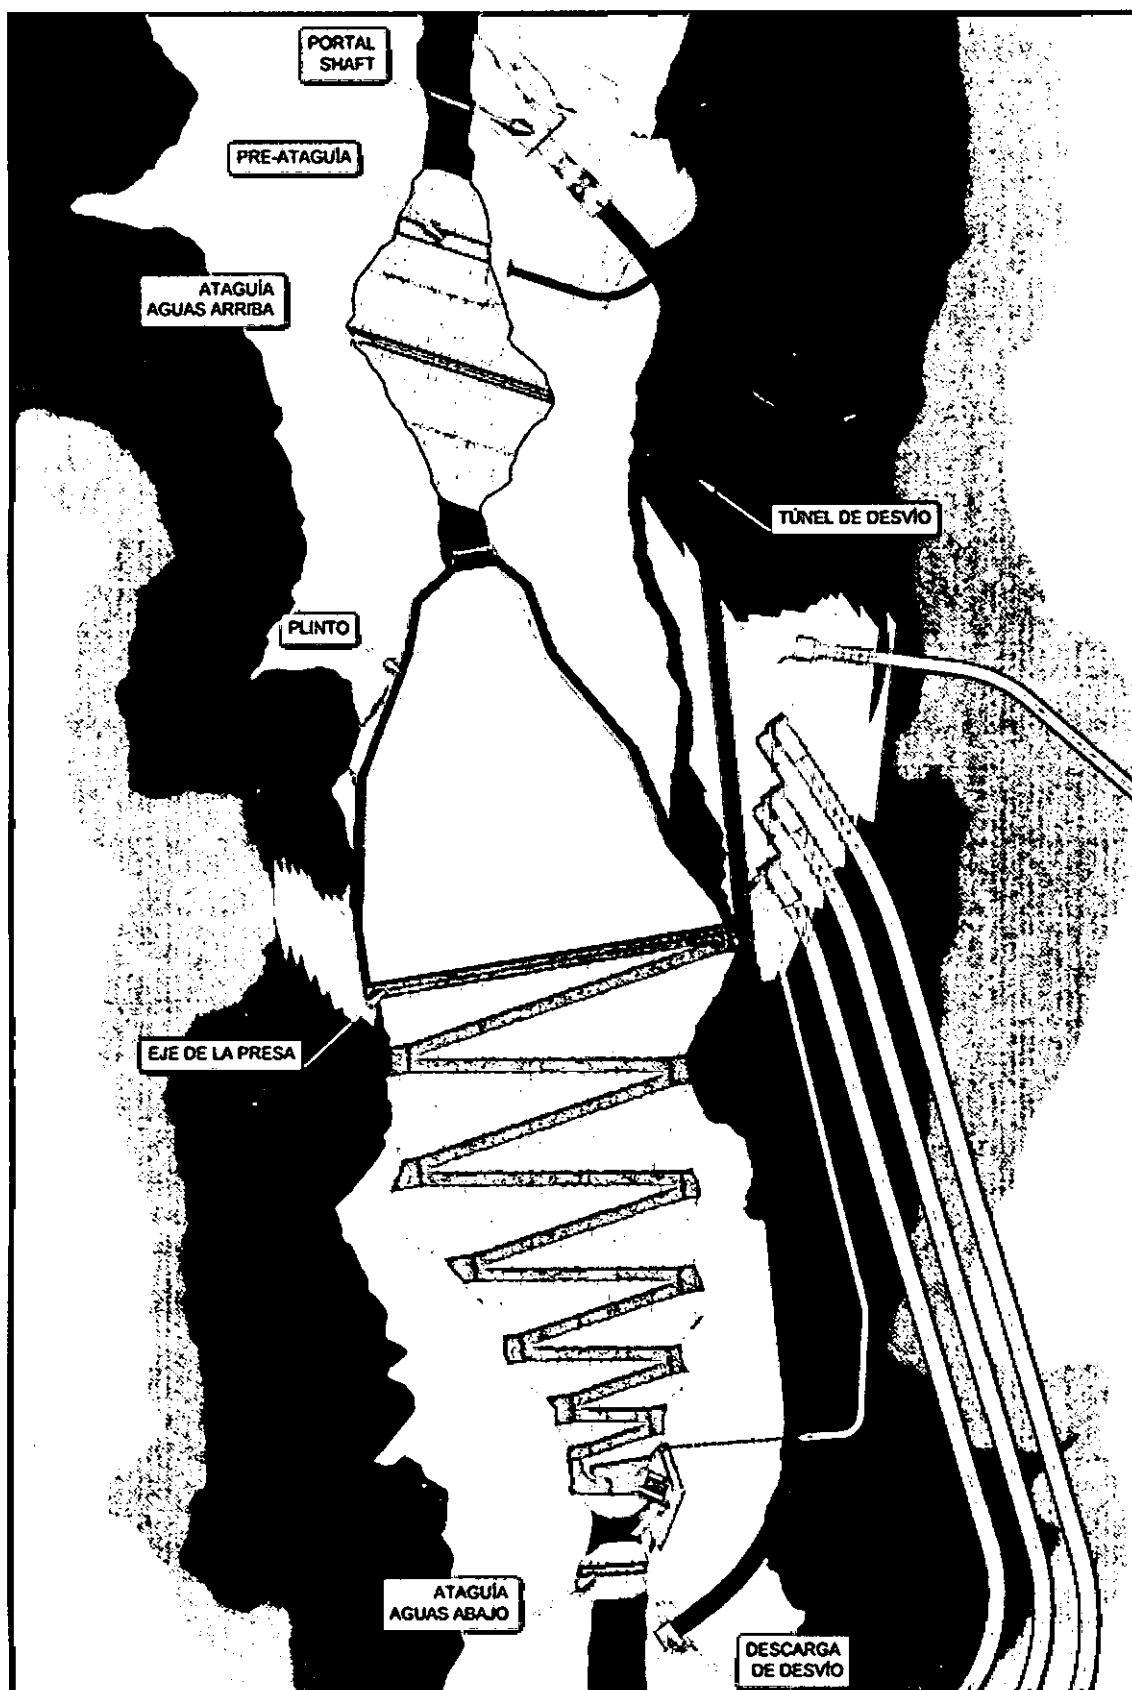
Zona de Presa – Túnel de Desvío. Esquema
